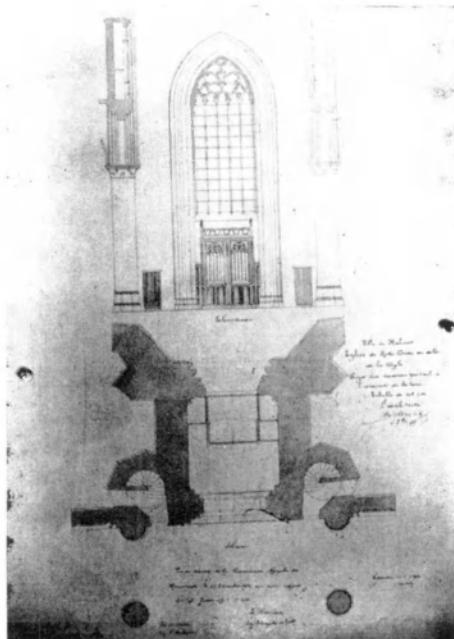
Projet d'un nouveau portail sous la tour. (Archives de l'église, plan n° 25).
